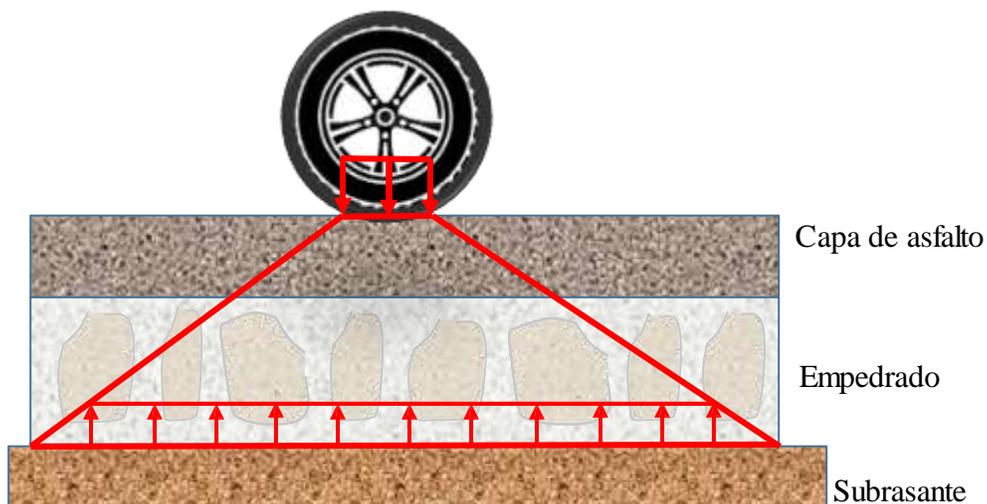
Comportamiento estructural de los pavimentos mixtos
